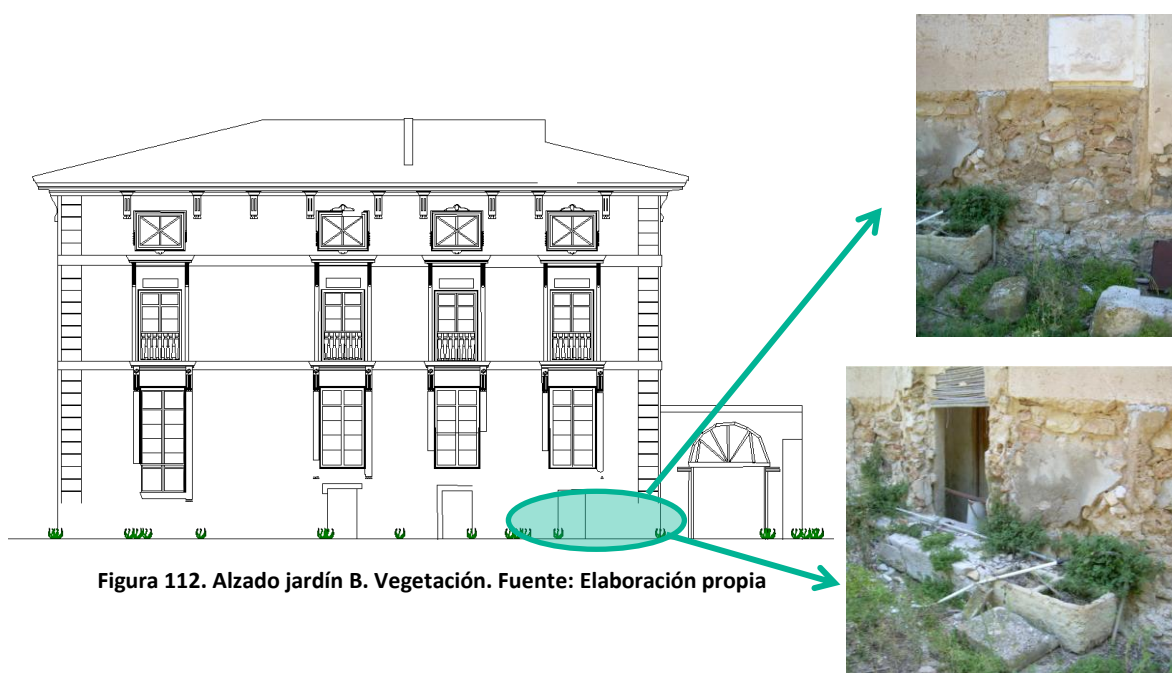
Alzado jardín B. Vegetación. Fuente: Elaboración propia
